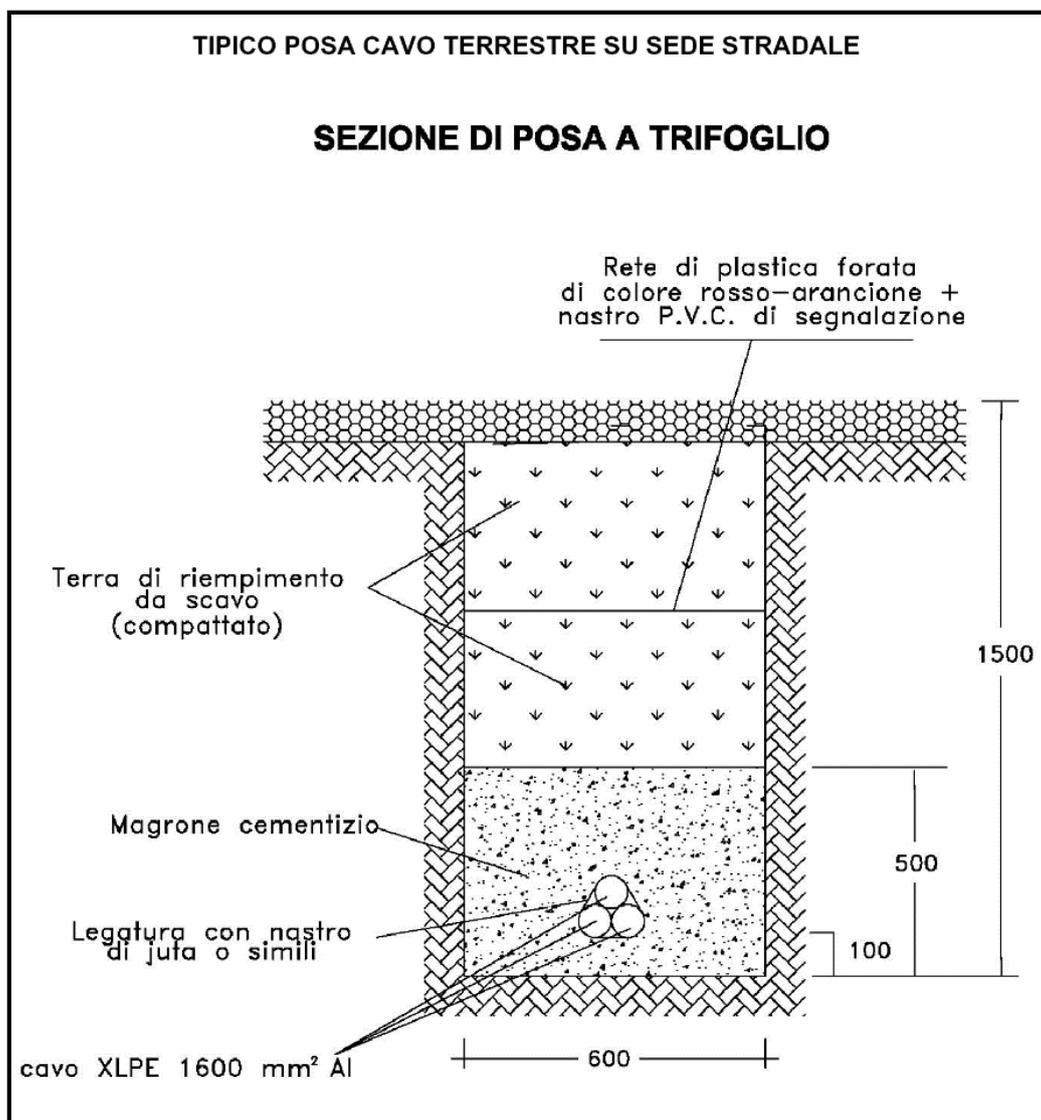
Modalità di disposizione delle fasi a trifoglio o in piano
